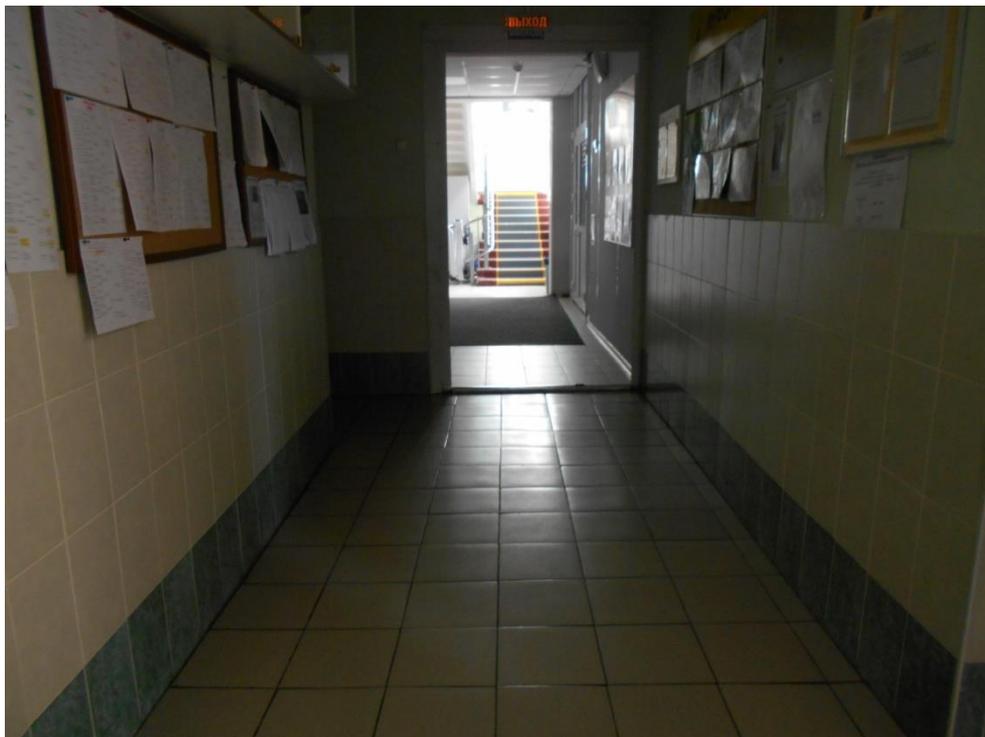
Коридор к лесенке 2ЛК. На плане № 13.
